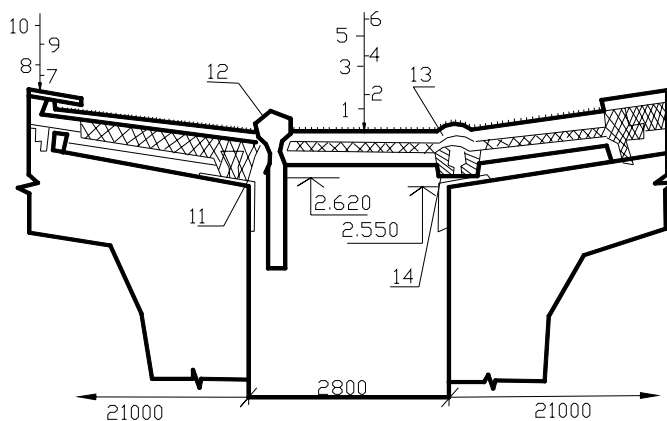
Поперечний переріз вставки блокового рамного каркасу:
